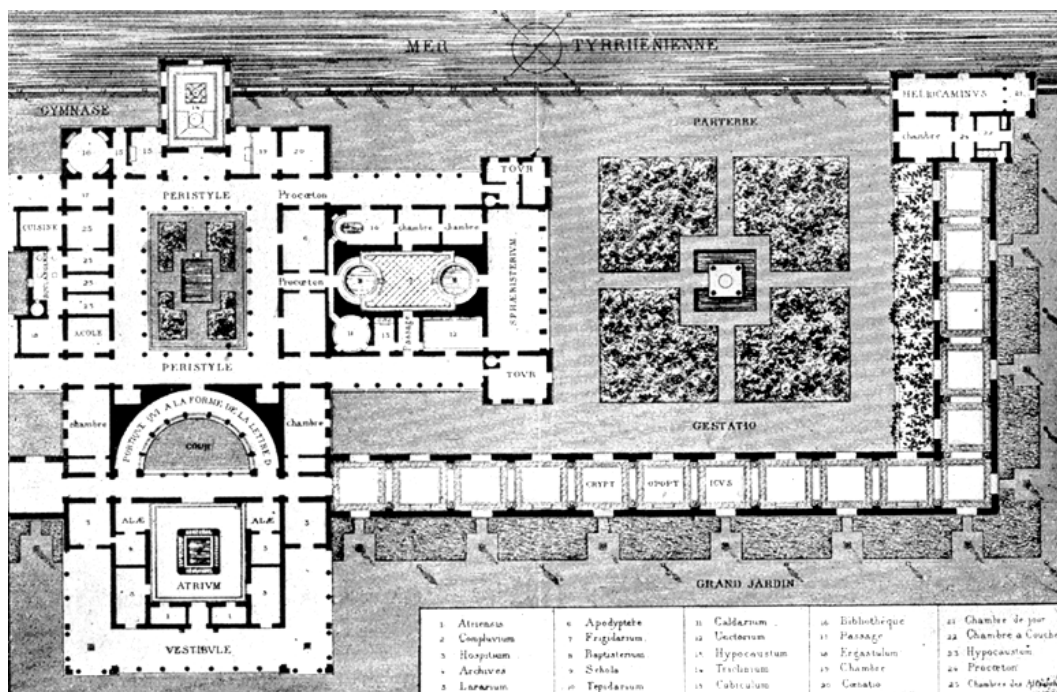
Planta da Villa Laurentina ilustrada por Louis Pierre Haudebourt
